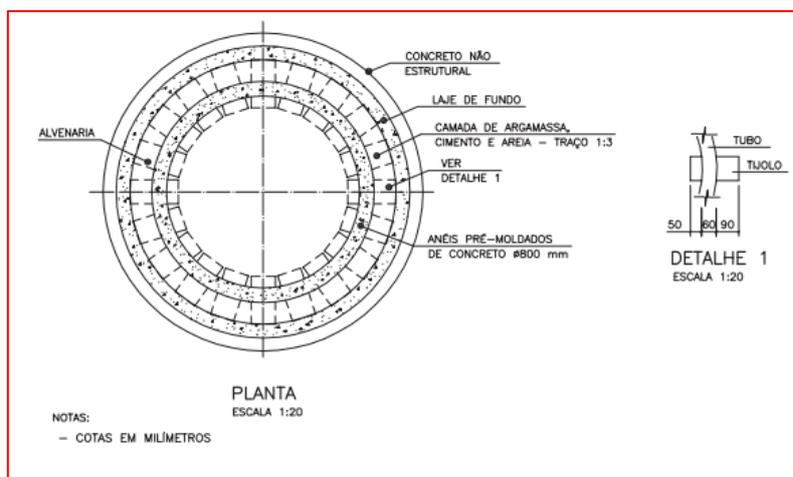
Execução de PV - tipo A - conforme SANEPAR - planta - Fonte: SANEPAR
